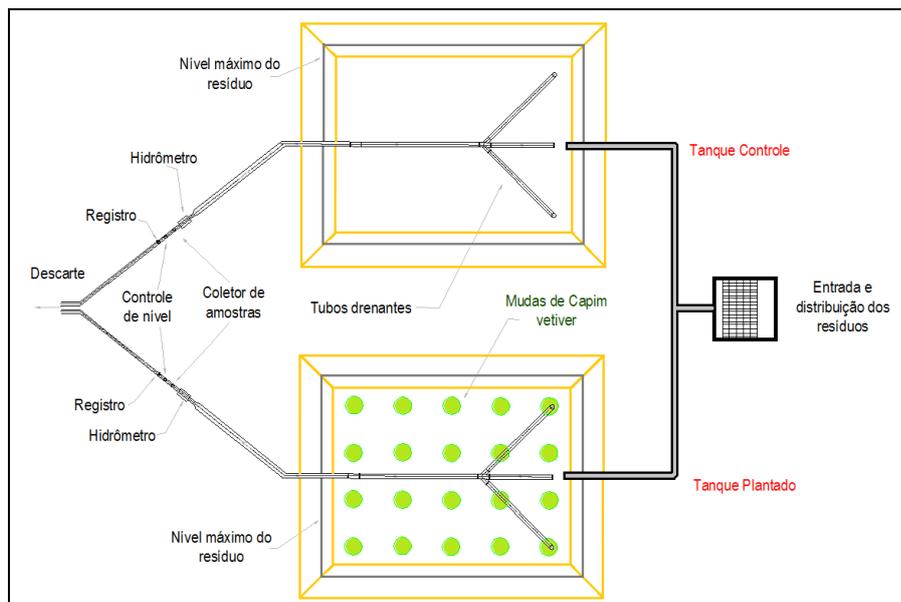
Planta representativa do sistema de alagados construídos implantado (sem escala).
